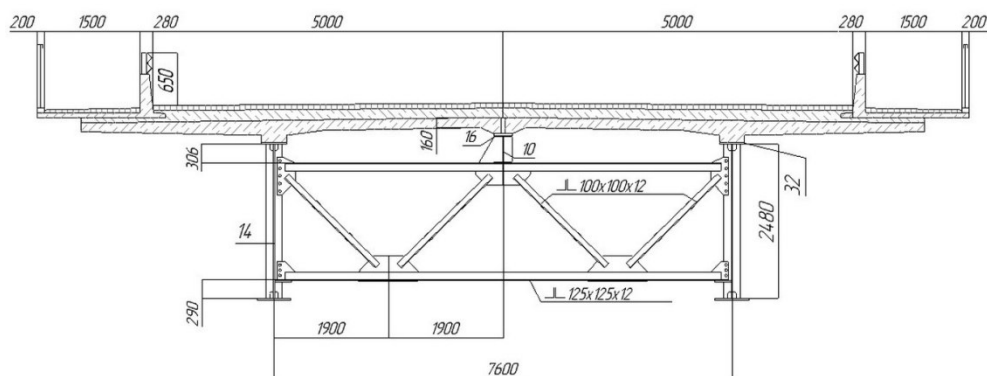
Поперечное сечение сталежелезобетонного пролетного строения
